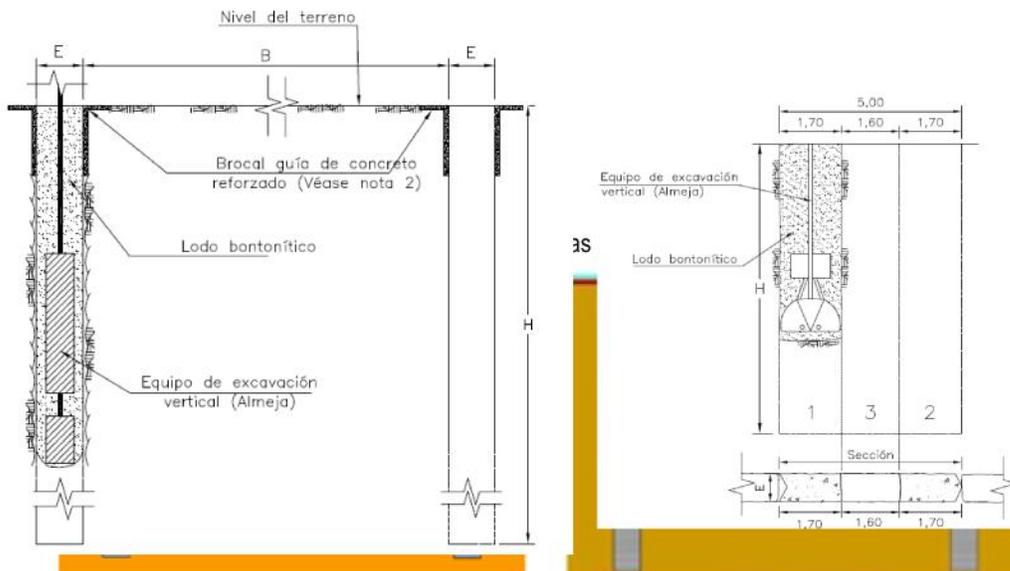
Excavación de pantalla preexcavadas (Cut & Cover)
